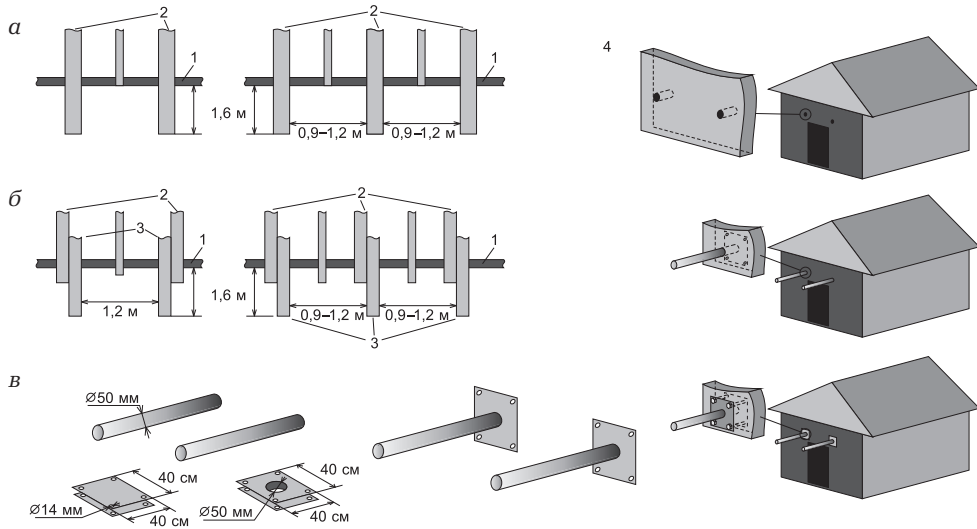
Установка полок по балкам: 1 — стена; 2 — балка; 3 — наращенная полка; 4 — монтаж полки сквозь стену
